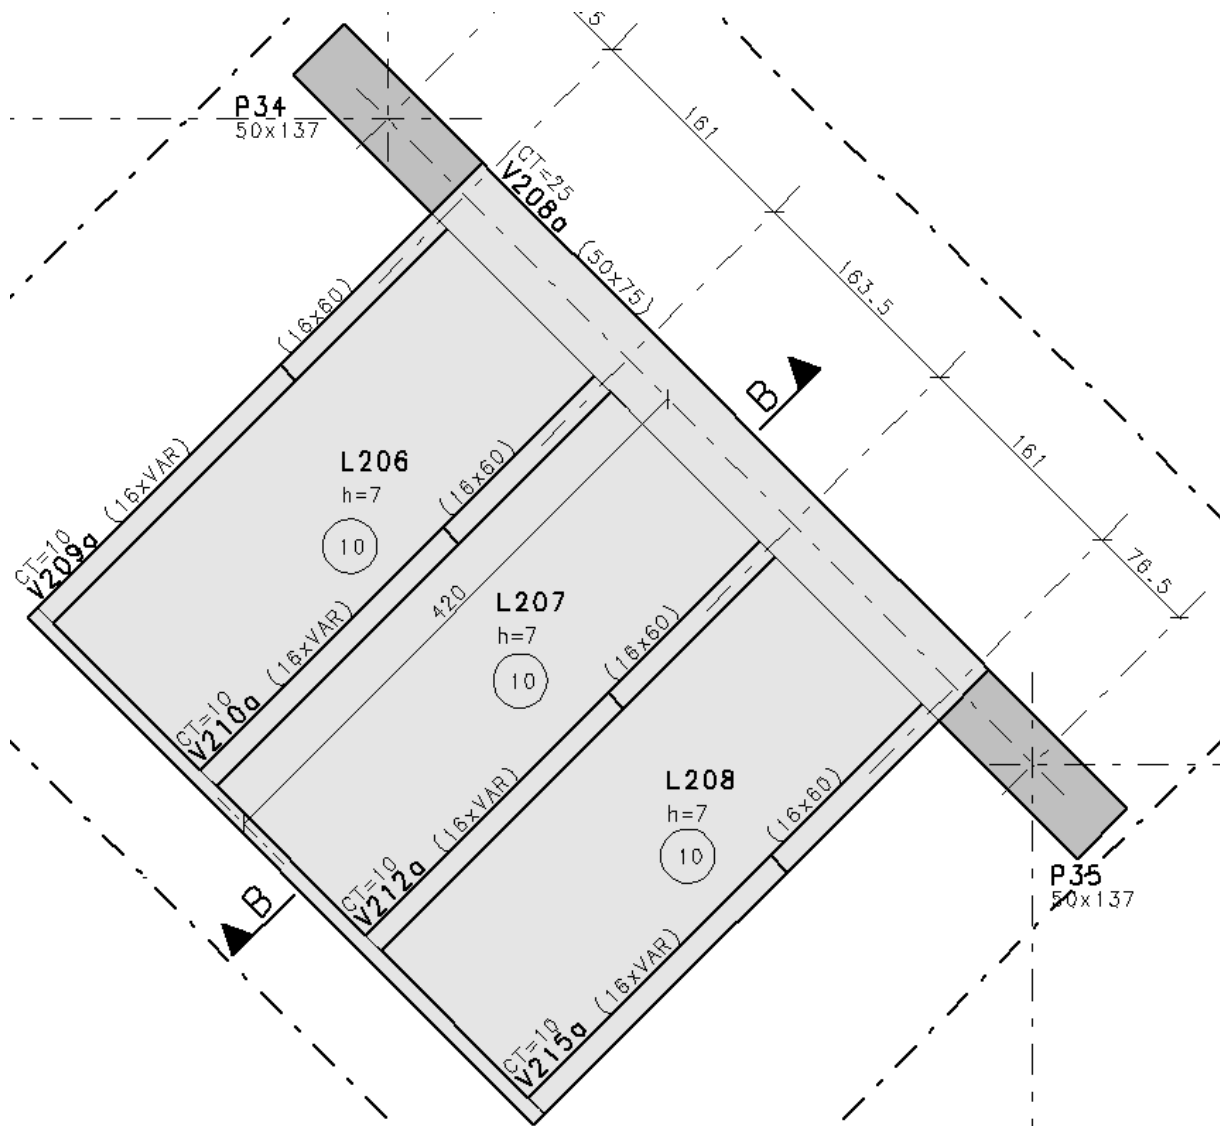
16 - Detalhe da forma do 1º pavimento - Marquise em planta.
